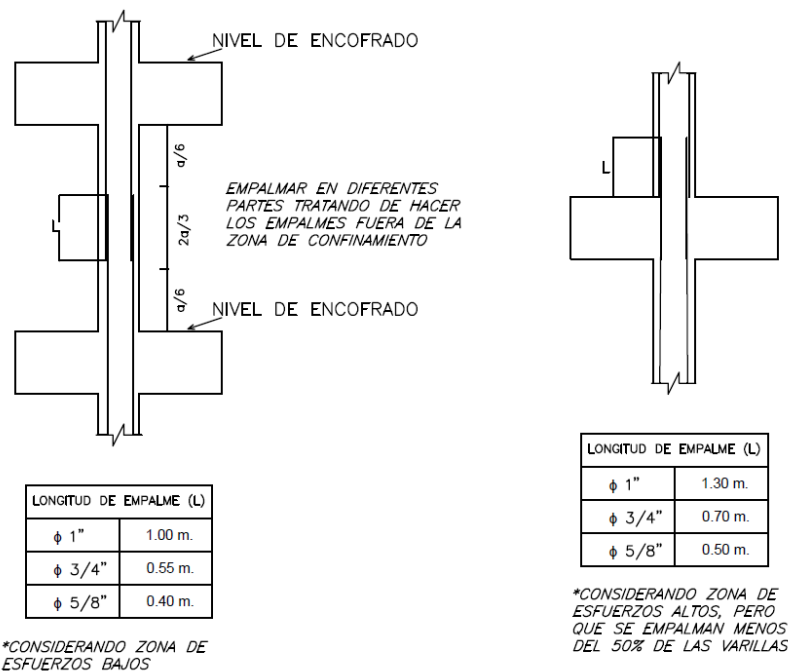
2 Consideraciones para el empalme del refuerzo en columnas (FUENTE: Blanco, 1994)
